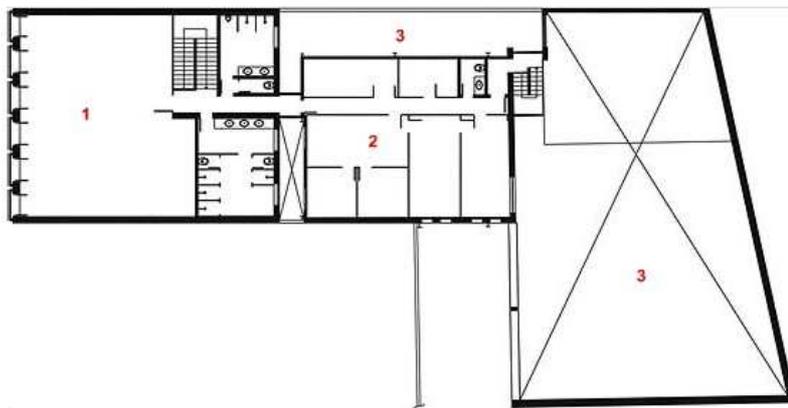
Planta terceiro pavimento (Fonte: ARCOWEB)
